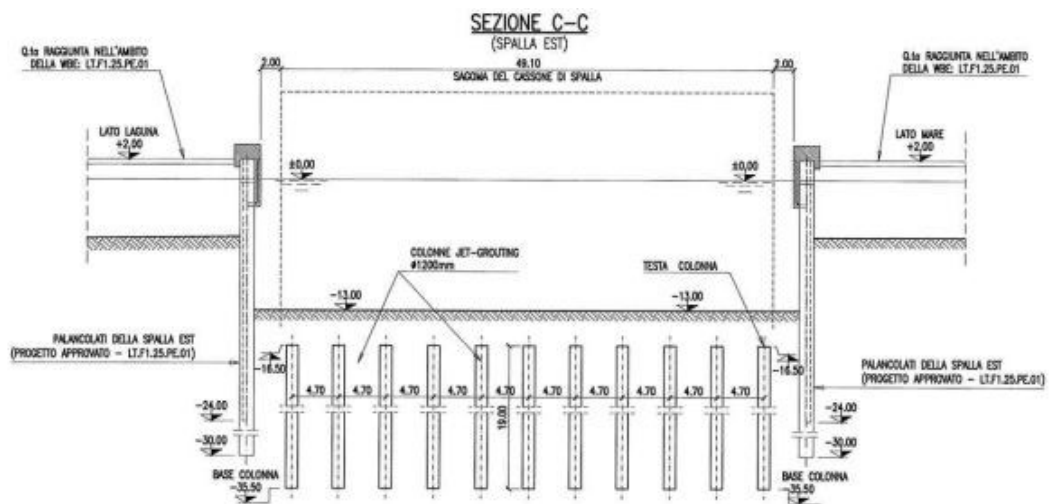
Sezione tipo cassone di spalla Est; estratto dagli elaborati grafici AS BUILT.
